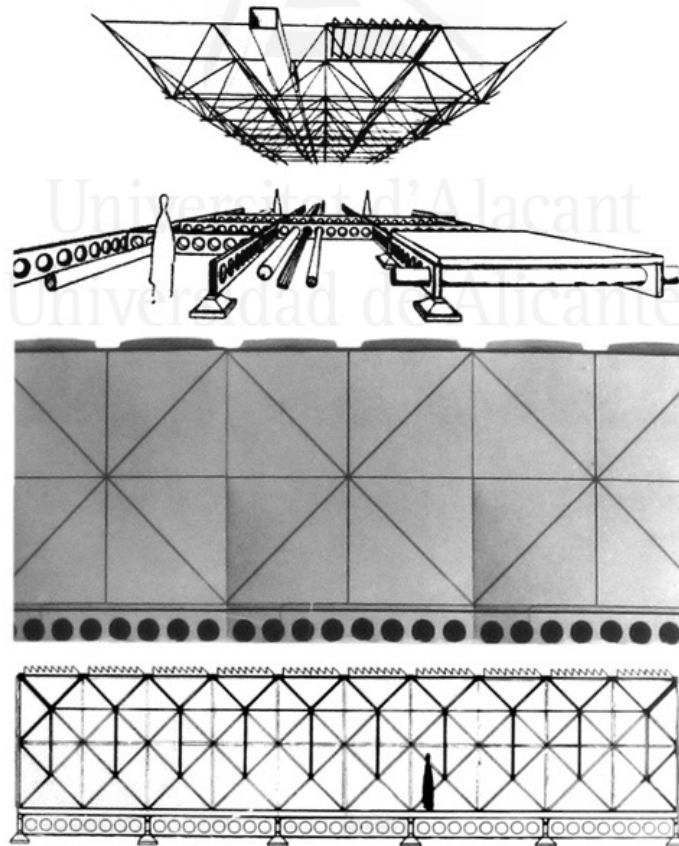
Sistema abierto para Laboratorios y Oficinas (1969), Renzo Piano. Croquis, fachada y sección. Ilustraciones extraídas de "Survey of Works" (Piano, 1973A, p.128).
